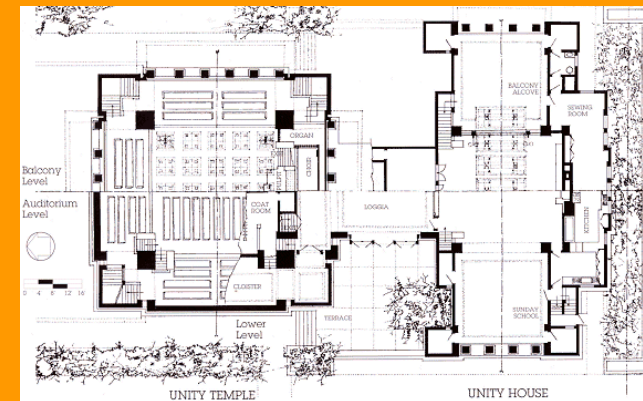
Unity Church - Frank Lloyd Wright - Planta
